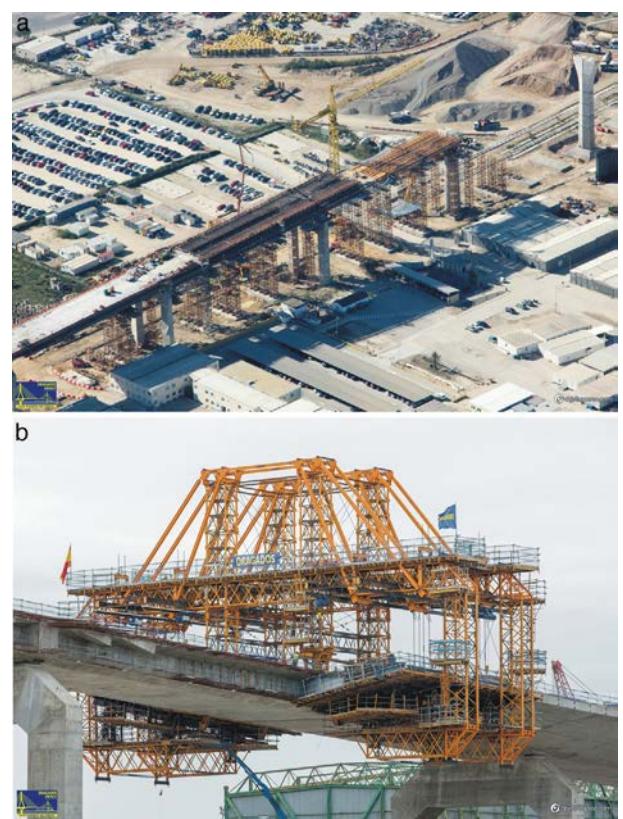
(a, b) Construcción del viaducto de acceso al lado de Puerto Real.
